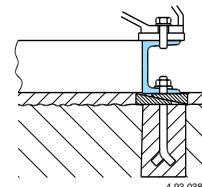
Фундамент для агрегата на опорной плите из сварного профиля.
